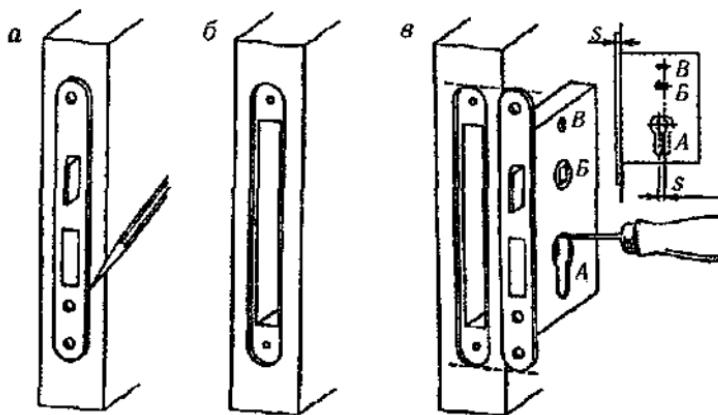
Врезка нового замка (продолжение): а — разметка выемки для планки; б — выборка паза под планку; в — сдвиг разметки на толщину планки замка.
